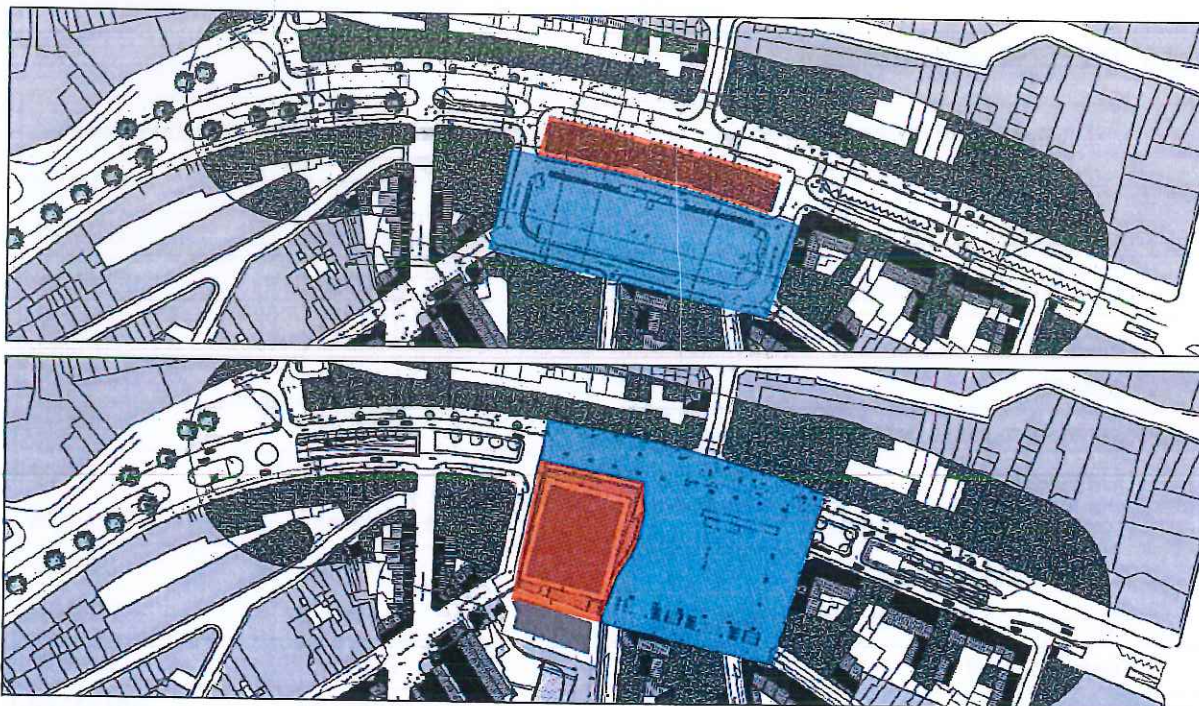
Plan du boulevard Joseph Tirou et la place Albert I^{er} en situation existante – en haut, et en situation projetée – en bas (source : DDS & Partners Architects)
